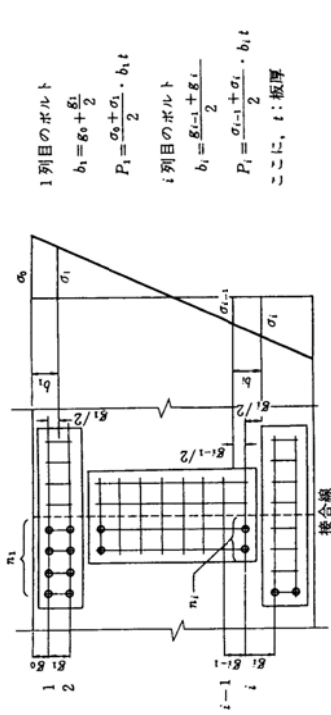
ボルトに作用する力 (垂直応力の分布が均等でない場合)
